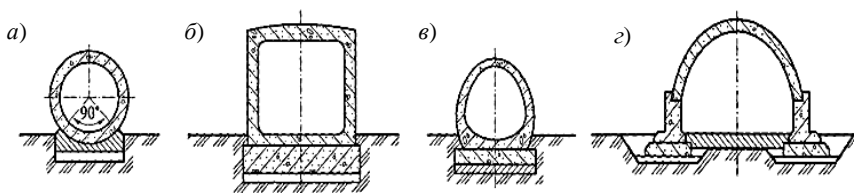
Типы поперечных сечений труб [52]:
